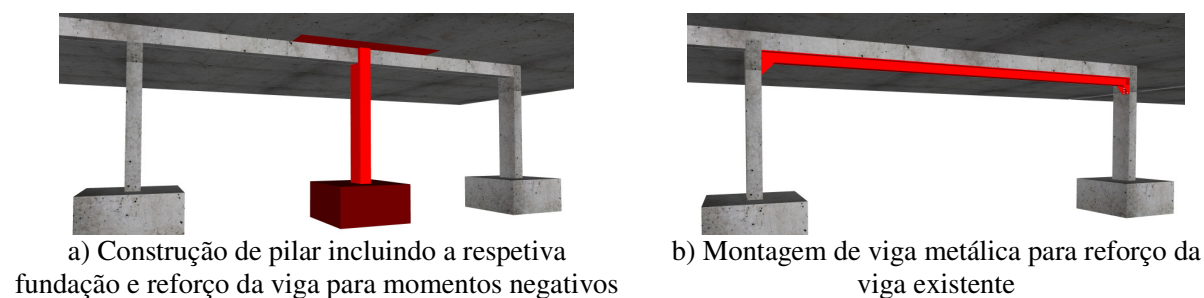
Técnicas alternativas de reforço por alteração estrutural de um vão (adaptado de [3])
